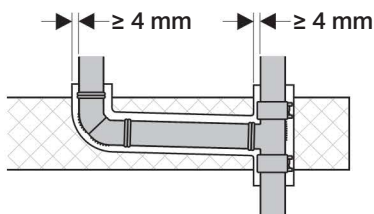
Bei einbetonierten Anschlussleitungen sind kraftschlüssige Verbindungen (Geberit Elektromuffen oder Spiegelschweissungen) einzusetzen. Die gesamte Leitung ist mit dem Geberit Dämmschlauch, der Geberit Bandage oder mit der Geberit Schalldämmmatte Isol Flex vom Baukörper zu entkoppeln.
